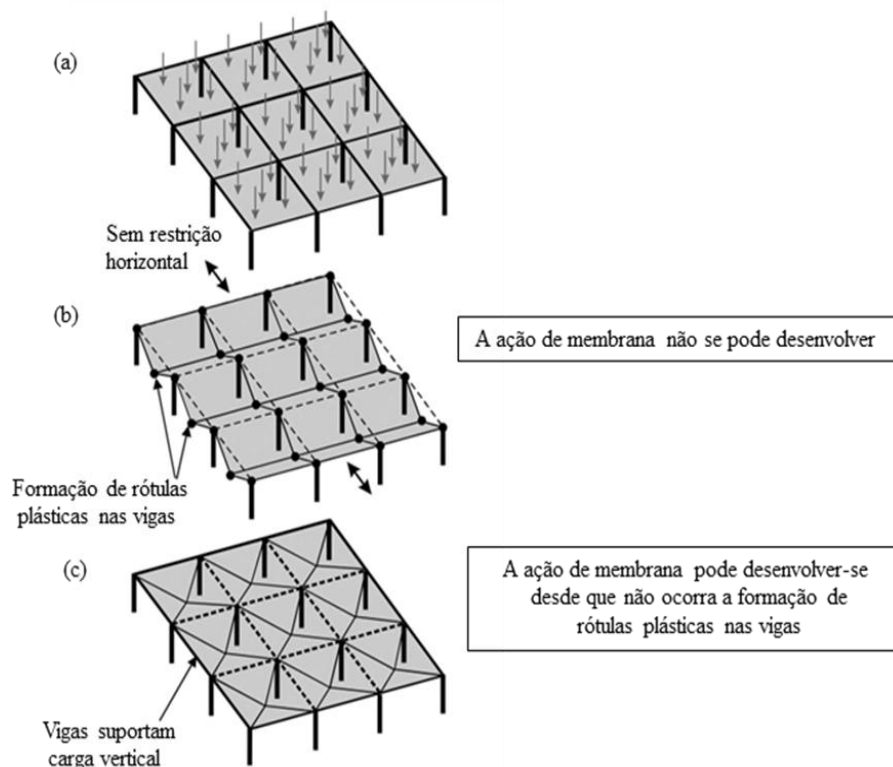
Rotura de flexão da laje de piso sob carga vertical crescente. (a) placa de piso sujeita a carga vertical crescente. (b) rotura da viga e do painel (rotulas plásticas formam-se nas vigas com as linhas de rotura da laje atraídas para as rotulas plásticas. (c) rotura do painel de laje (sem formação de rotulas plásticas nas vigas, um mecanismo de linhas de rotura forma-se em painéis individuais de laje) (C.G. Bailey, 2004).
